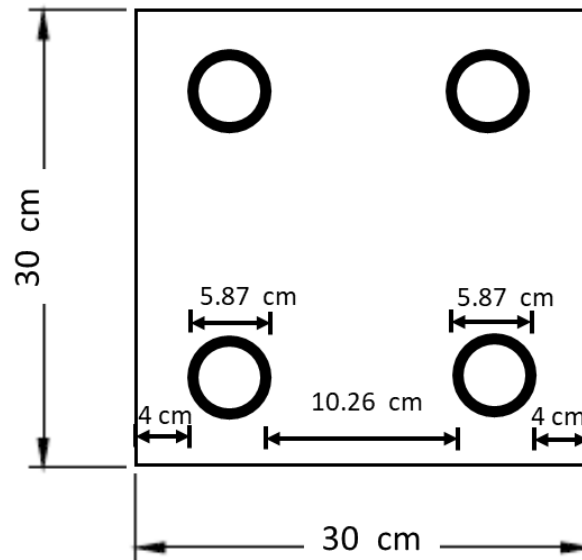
Colocación de refuerzo de bambú. Fuente: Comportamiento a flexión de una viga de concreto reforzada con bambú guadua, Lima 2021 (Sanchez, 2022)
